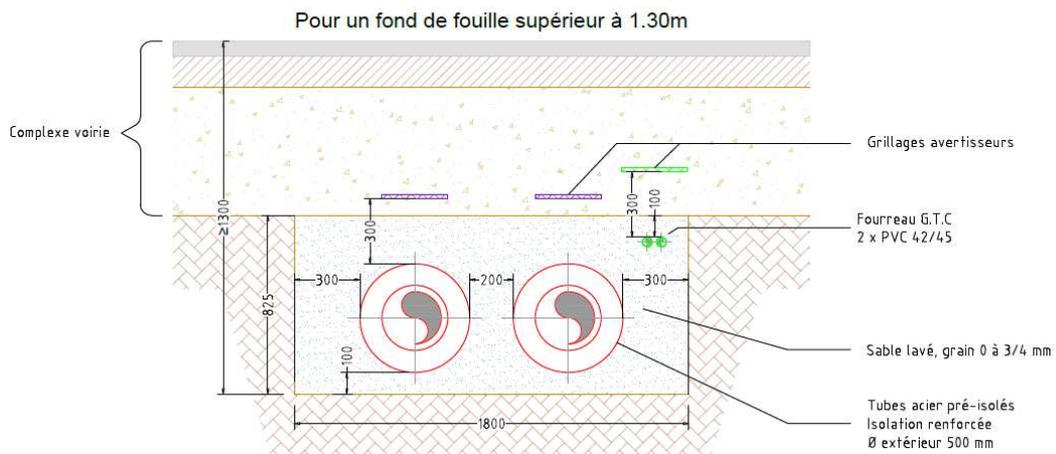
Coupe type - exemple 2 (profondeur > 1.3 m)
